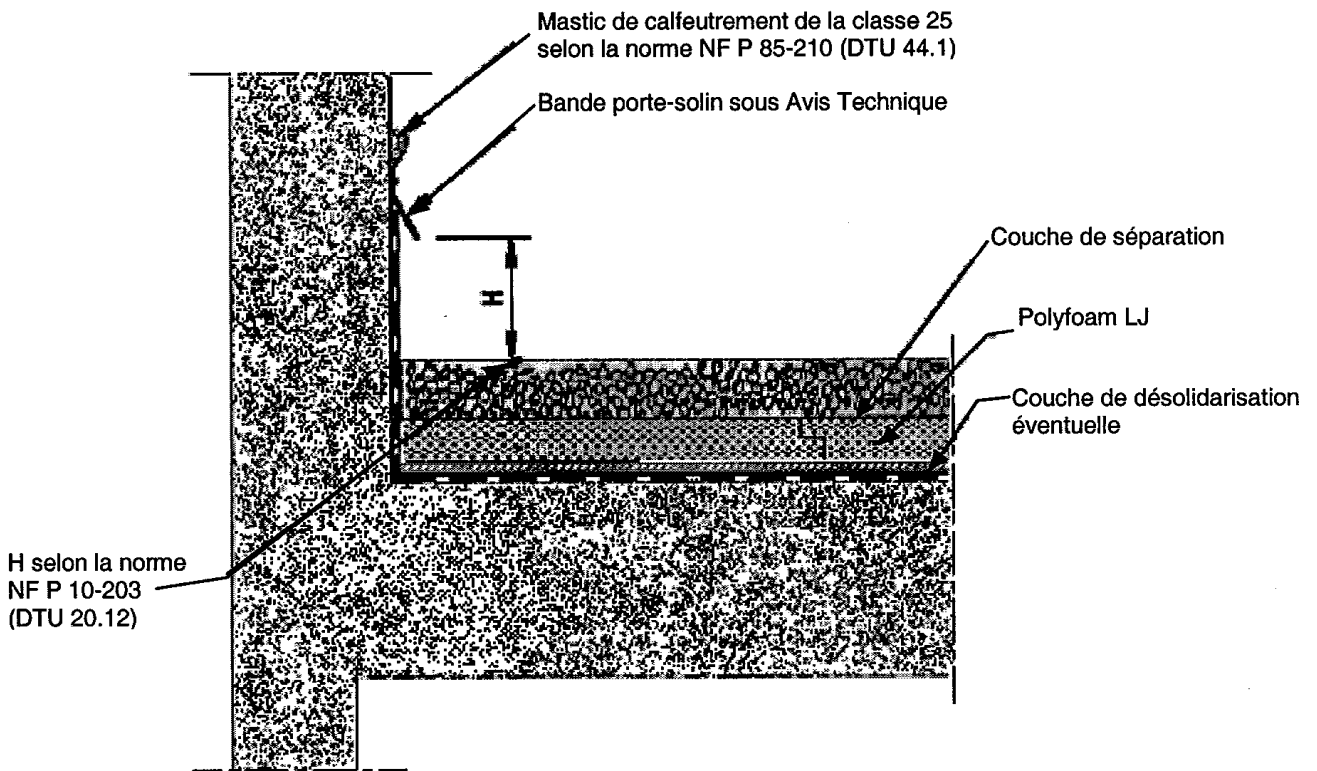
Toiture existante, rehaussement du relevé d'étanchéité
